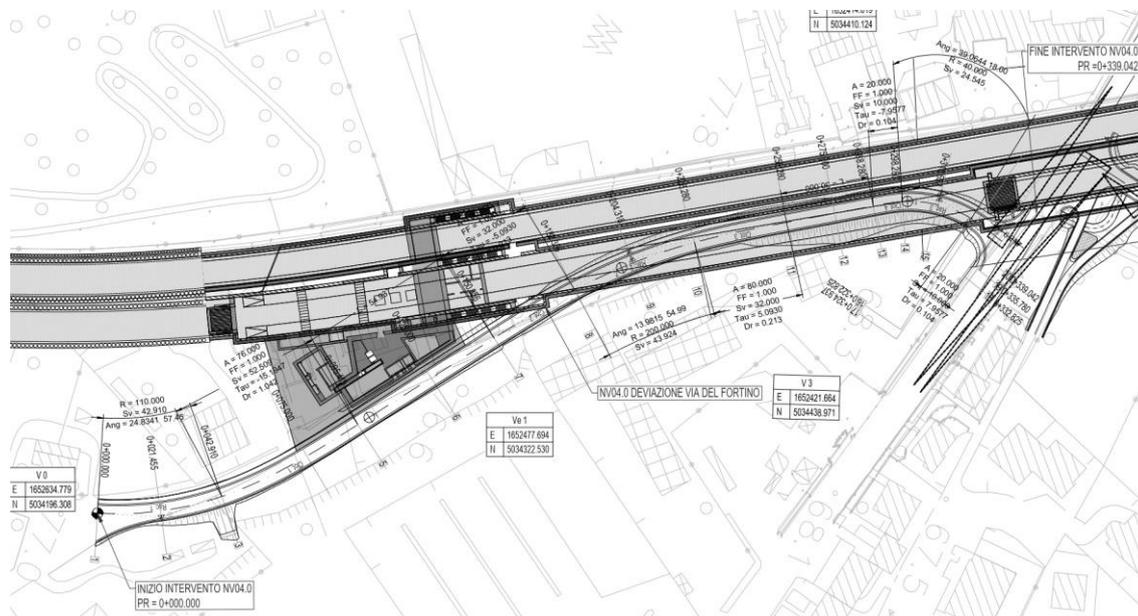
NV04 – Stralcio planimetrico su rilievo Via del Fortino (tratto Nord)
